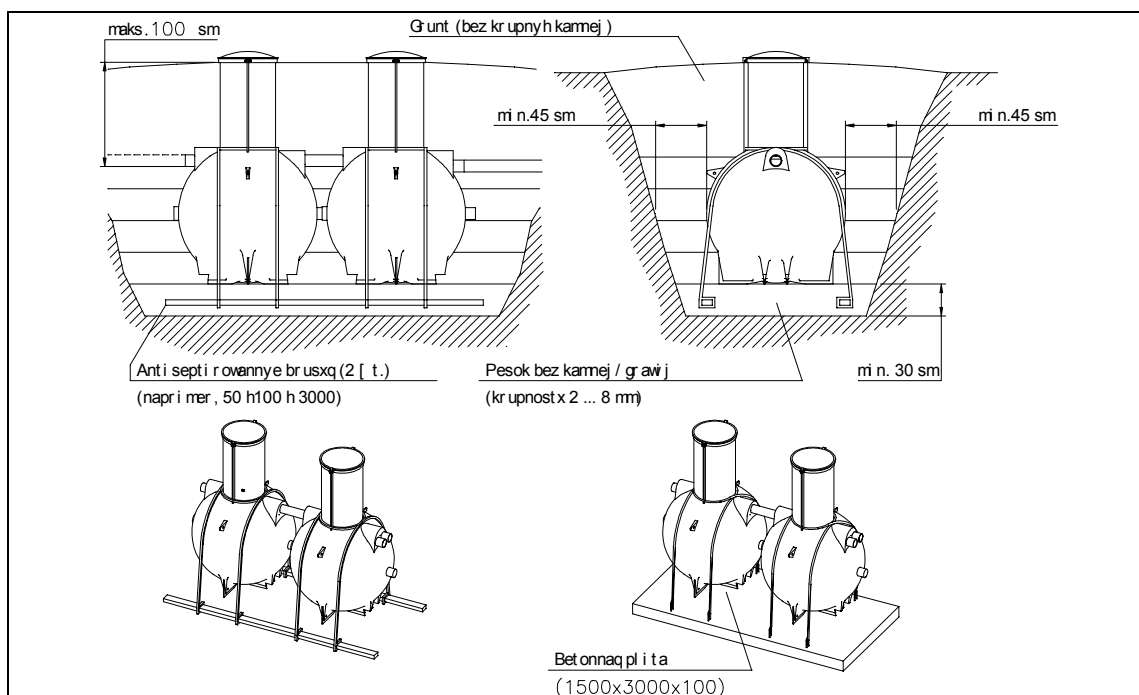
Установка и крепление системы Labko® SAKO-3 Twin на антисептированных брусках или на бетонной плите.
